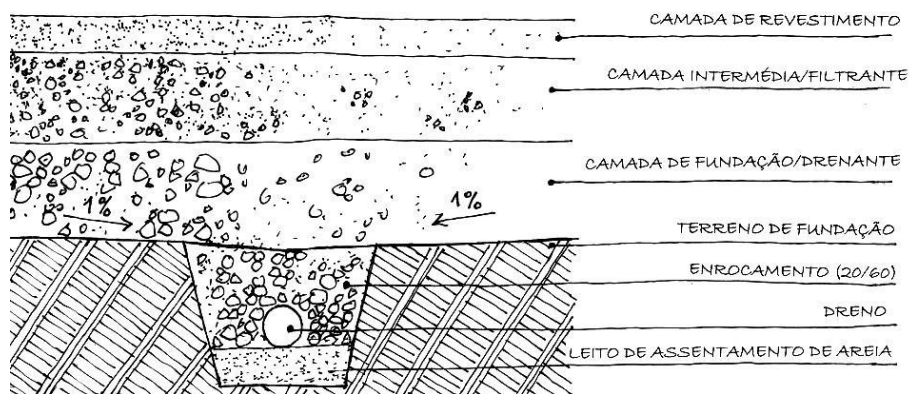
Pormenor esquemático do pavimento - Instalações cobertas
